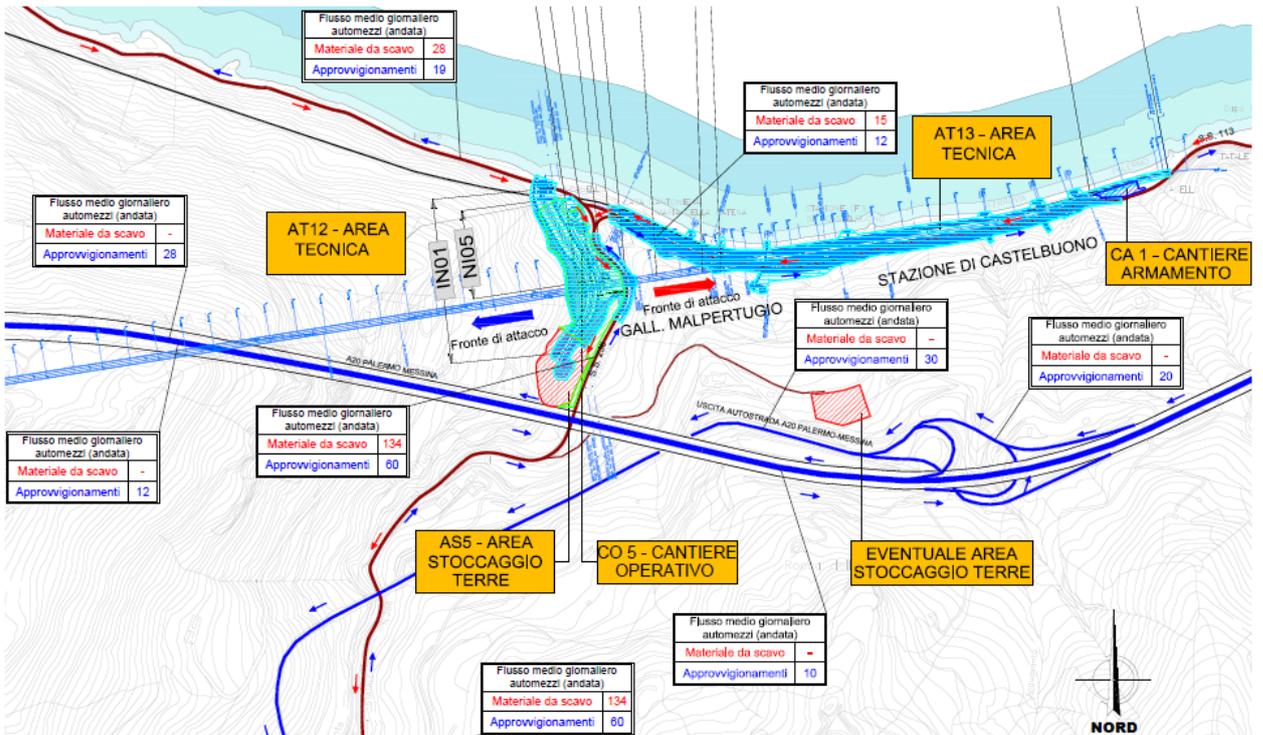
Stralcio planimetria dei flussi area Malpertugio- Castelbuono
